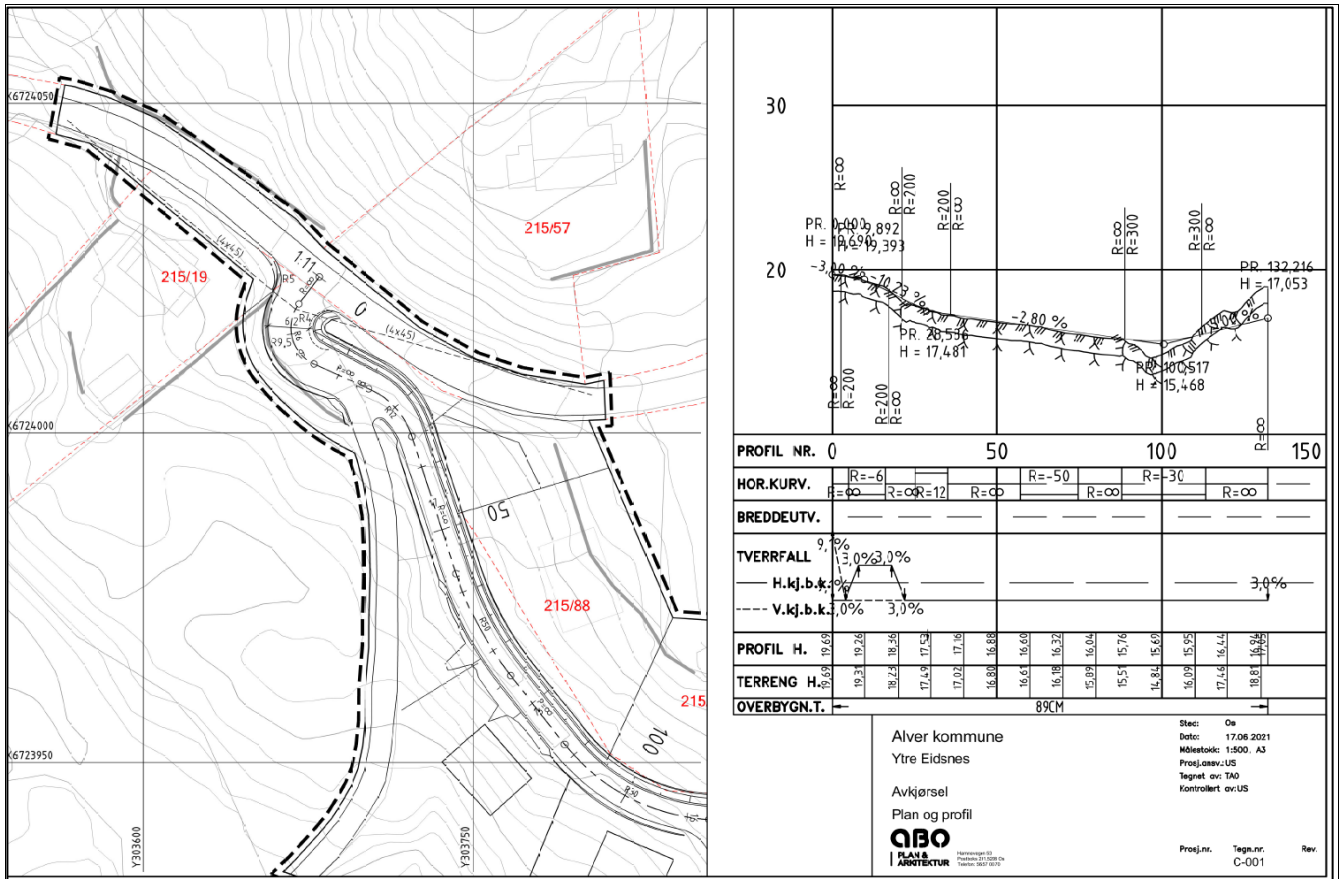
Utsnitt av plankart som viser avkjørsel til planområdet.
